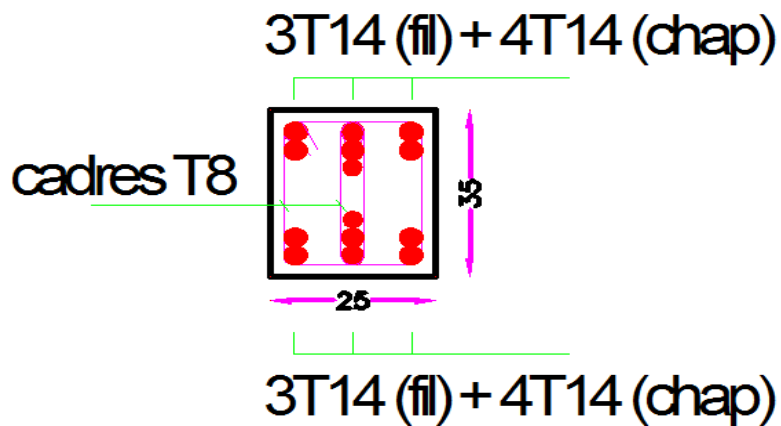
Ferraillage des poutres secondaire loin des voiles
